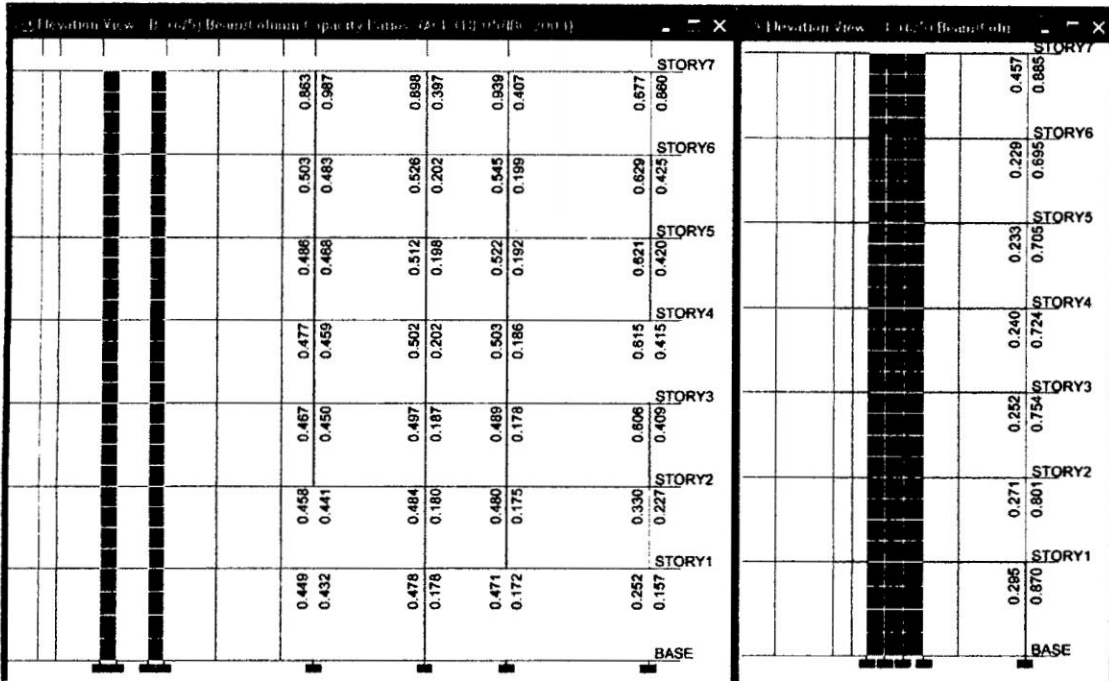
Revisión de columna fuerte viga débil con Etabs en el eje B-B y 3-3
